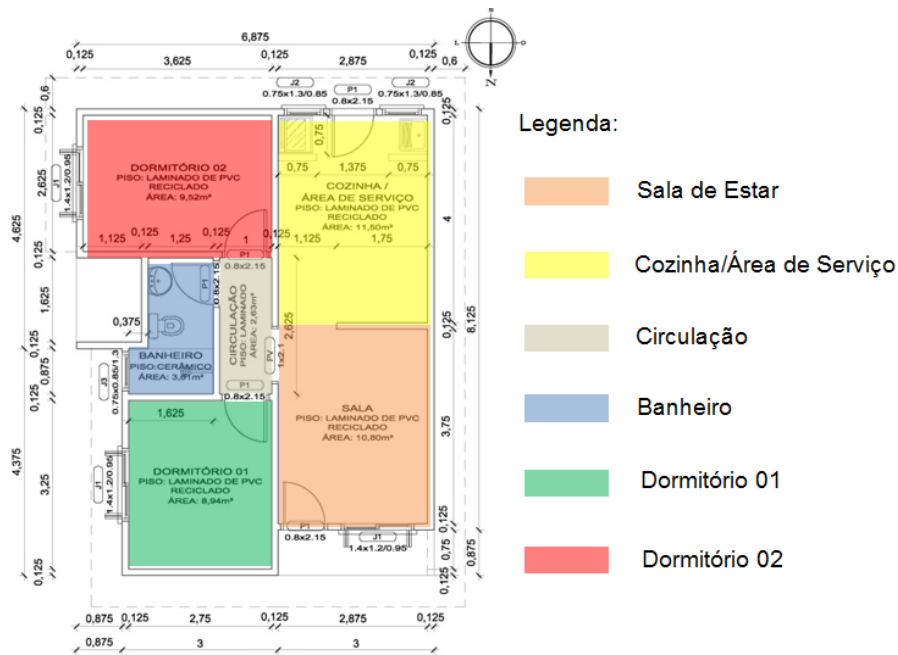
Planta baixa esquemática do protótipo de habitação de interesse social construído na UFSM.
